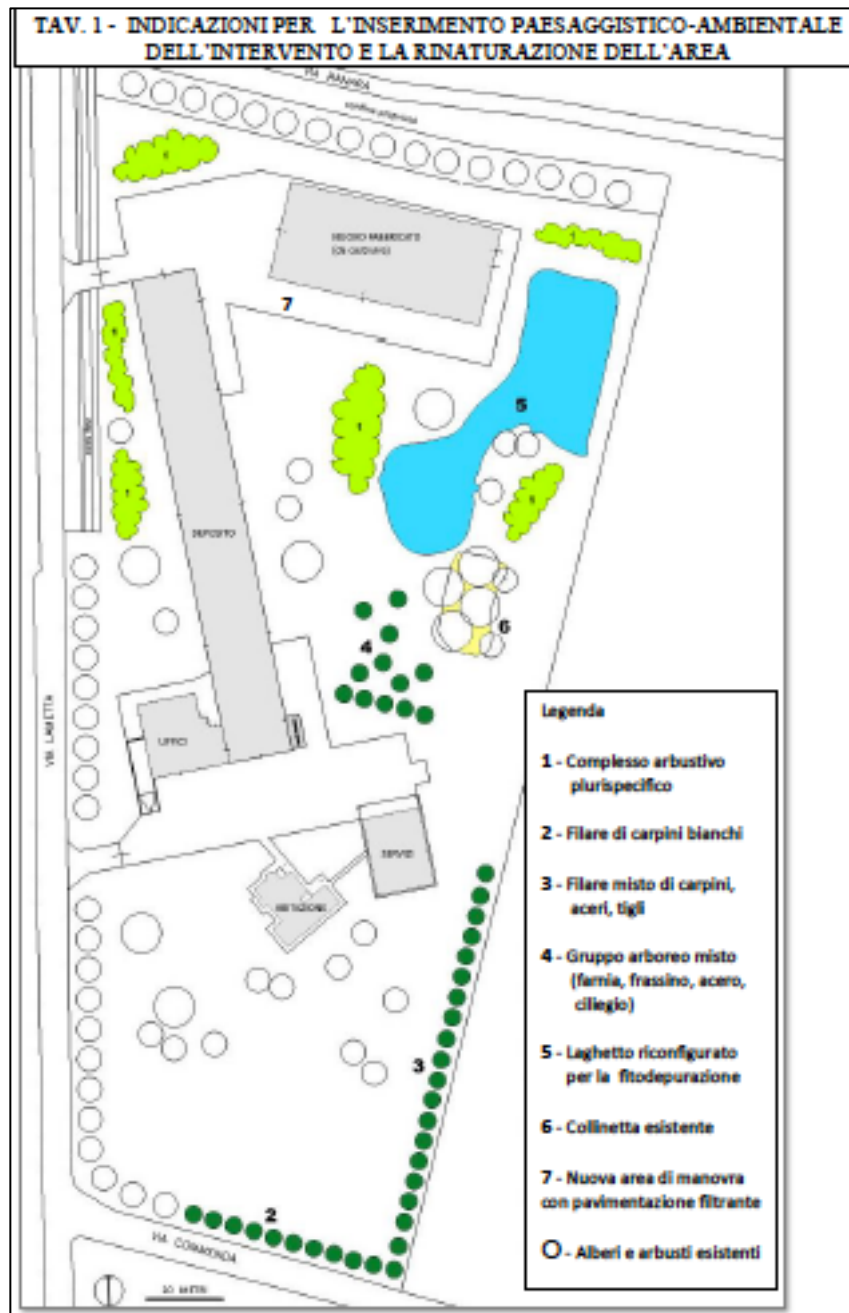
Planimetria progetto paesaggistico (estratto da Alleg. 12.1 relazione paesaggistica)
